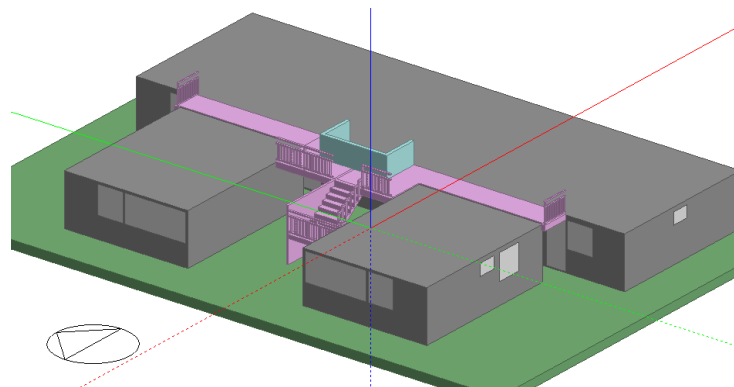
Creación de los detalles arquitectónicos de la edificación en DesignBuilder.
